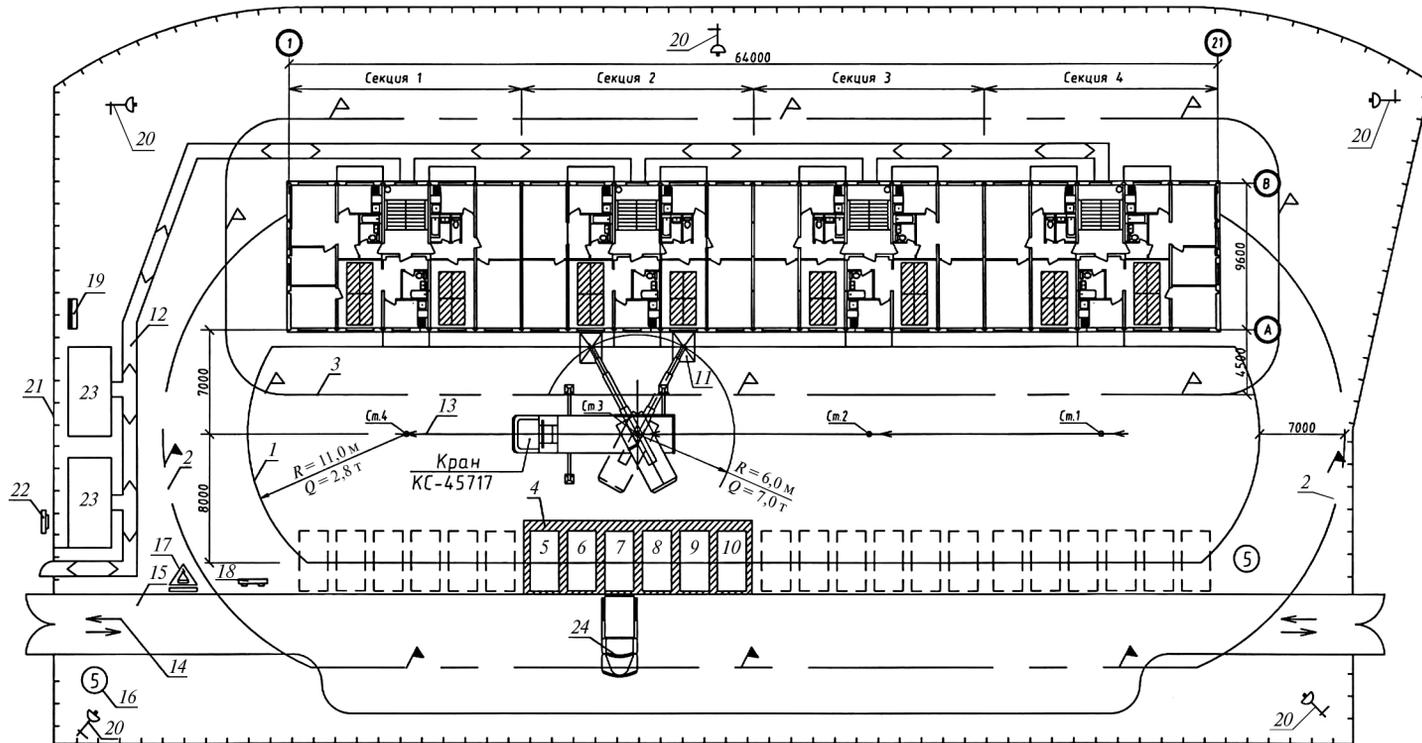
Стройгенплан разбираемого жилого дома серии II-32
